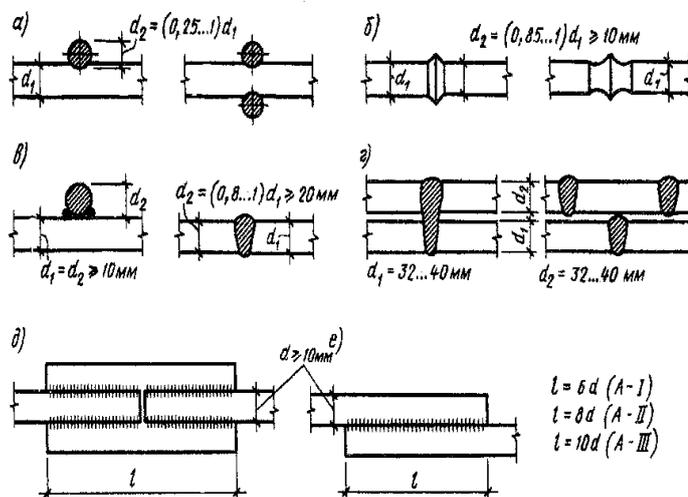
Сварные стыковые соединения арматуры
